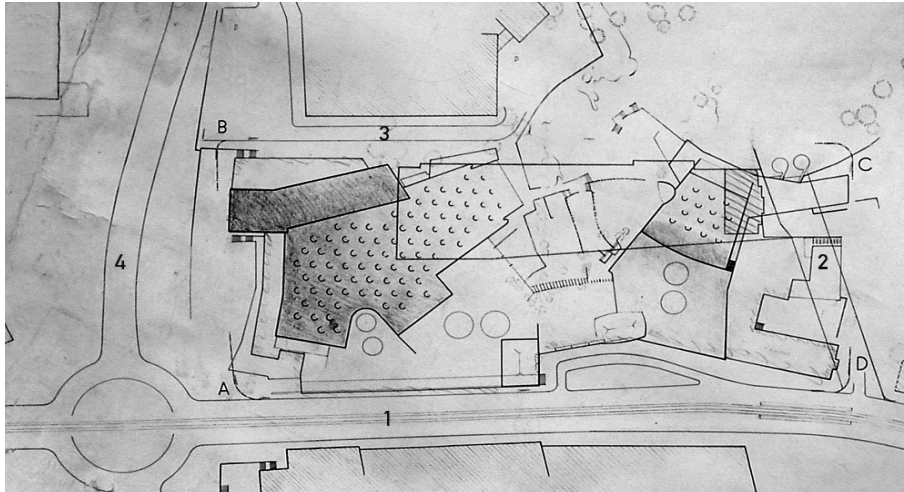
Wettbewerb Lageplan, Scharoun, 1949.
